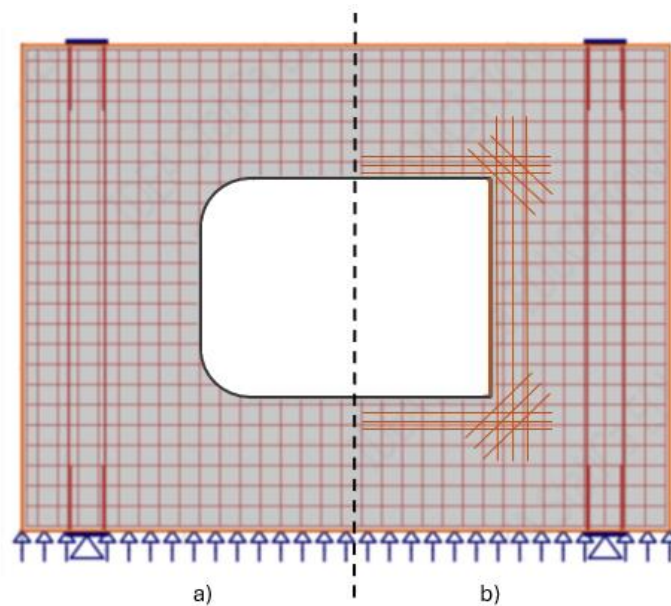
Alternativas para a redução de tensões atuantes no betão devido a a) arredondamento dos cantos; b) armadura de reforço localizada.
